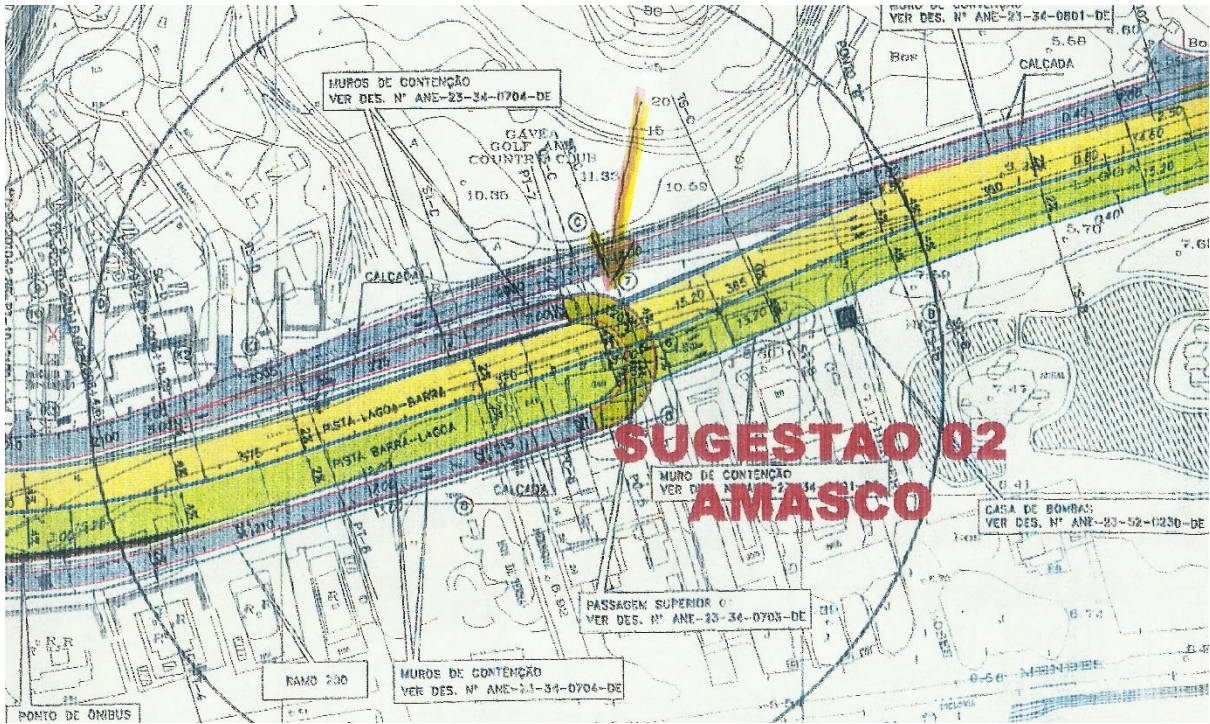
Projeto de modernização e ampliação da Autoestrada Lagoa-Barra
